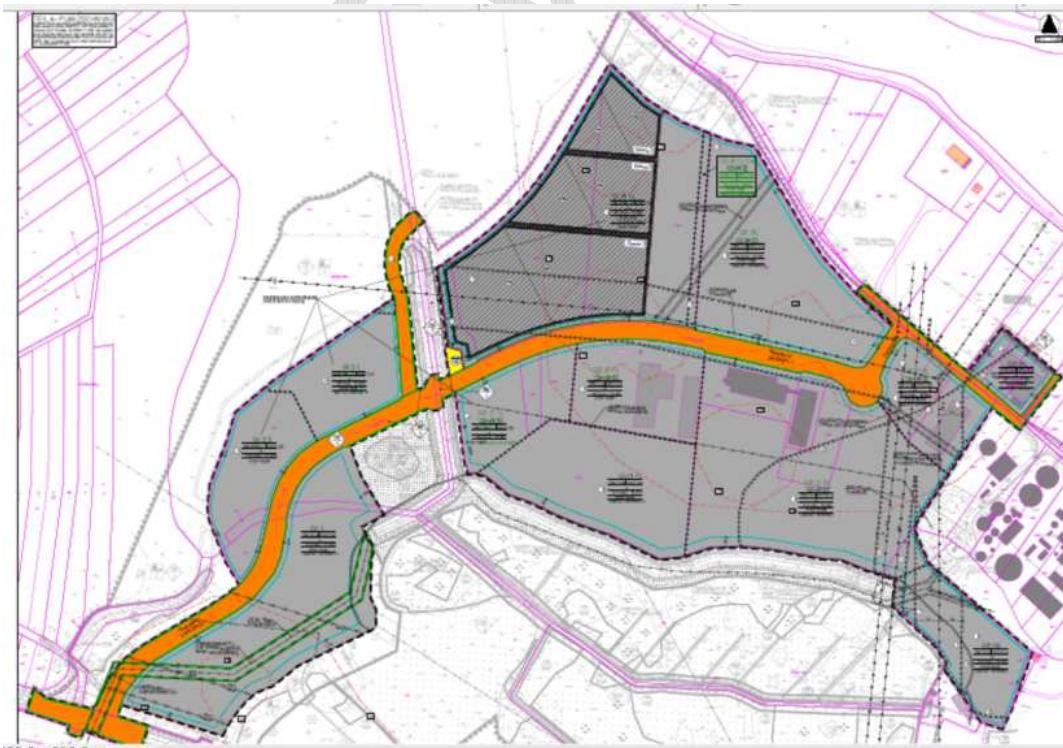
Entwurf zur 2.Änderung des B-Plan 29 (© Planungsbüro Mahnel)
